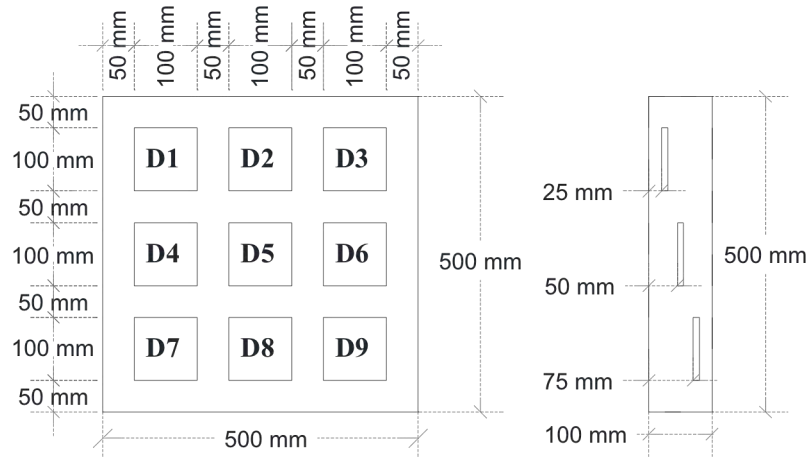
Posición de las delaminaciones en las probetas de hormigón
